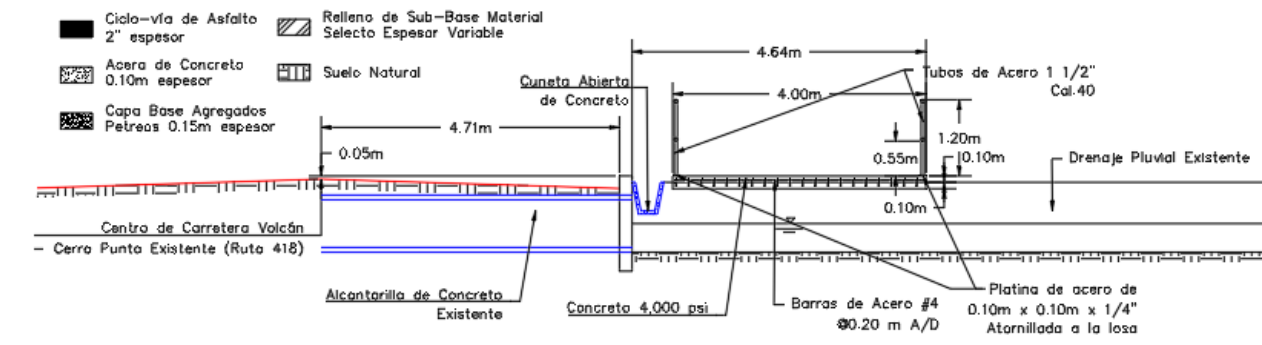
Sección Transversal 1/A de Cajón Pluvial en la estación 0K+003 m.
